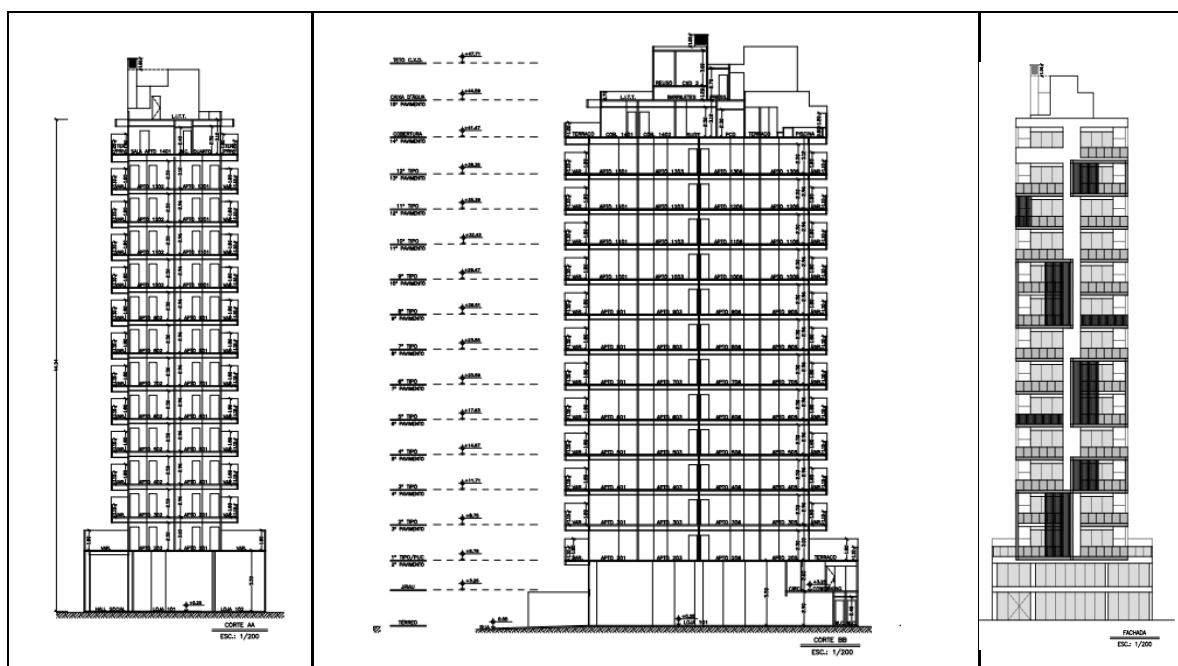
Fachada e Cortes - Fonte Projeto Legal
